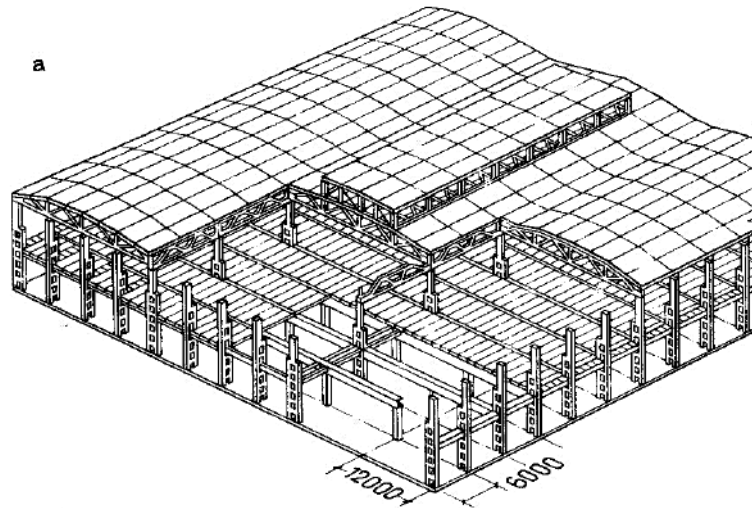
Загальний вигляд одноповерхової промислової будівлі
